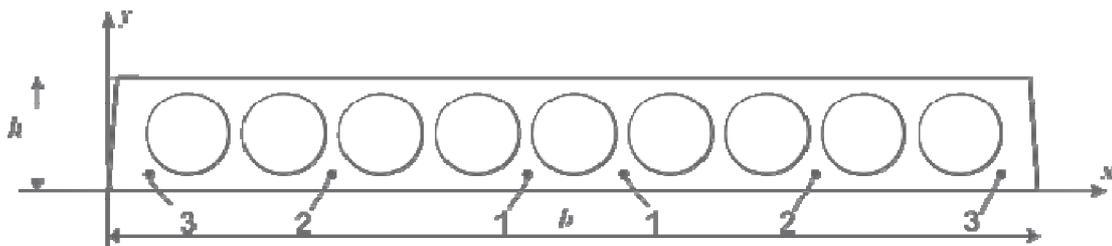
Поперечний розріз залізобетонної плити перекриття
